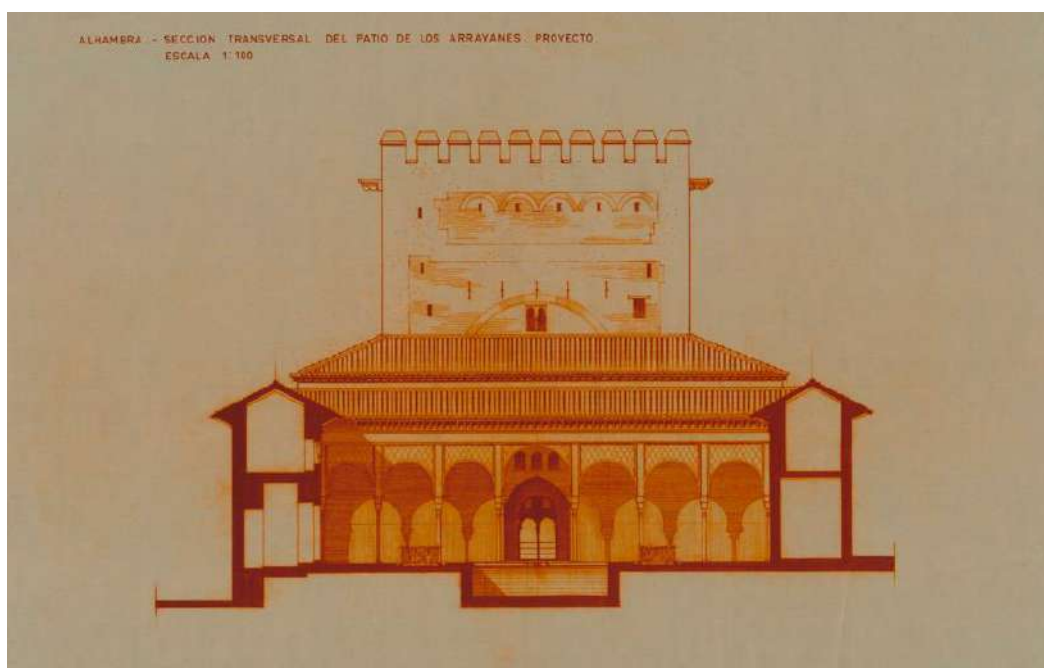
Sección transversal del Patio de Arrayanes hacia el pórtico norte. Estado propuesto. Manuel López Reche (delineante), Prieto-Moreno, 1957-1963. (APAG/Colección de Planos/002493).
